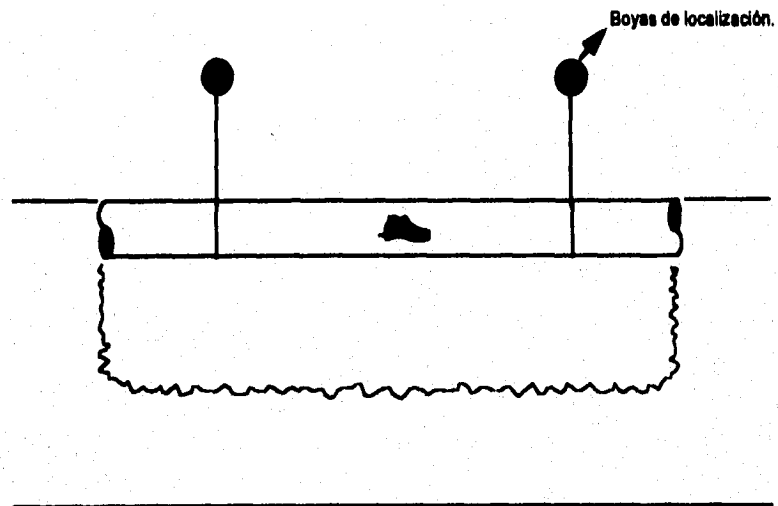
, tubería y terreno listo para los trabajos de soldadura.
